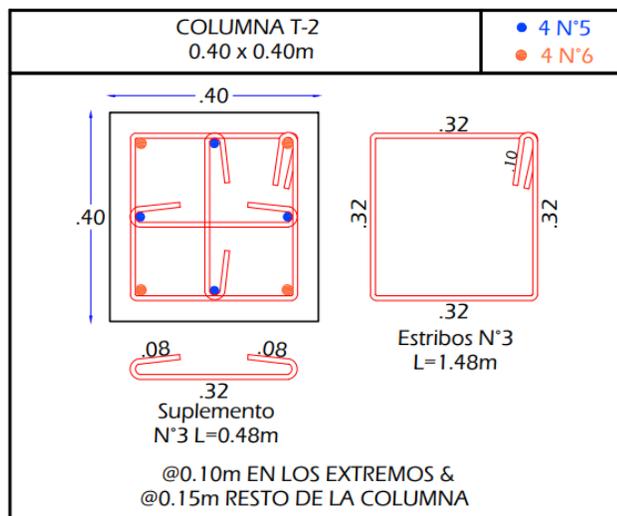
Despiece de columnas T2 nivel 4 Edificio Wiedii.
